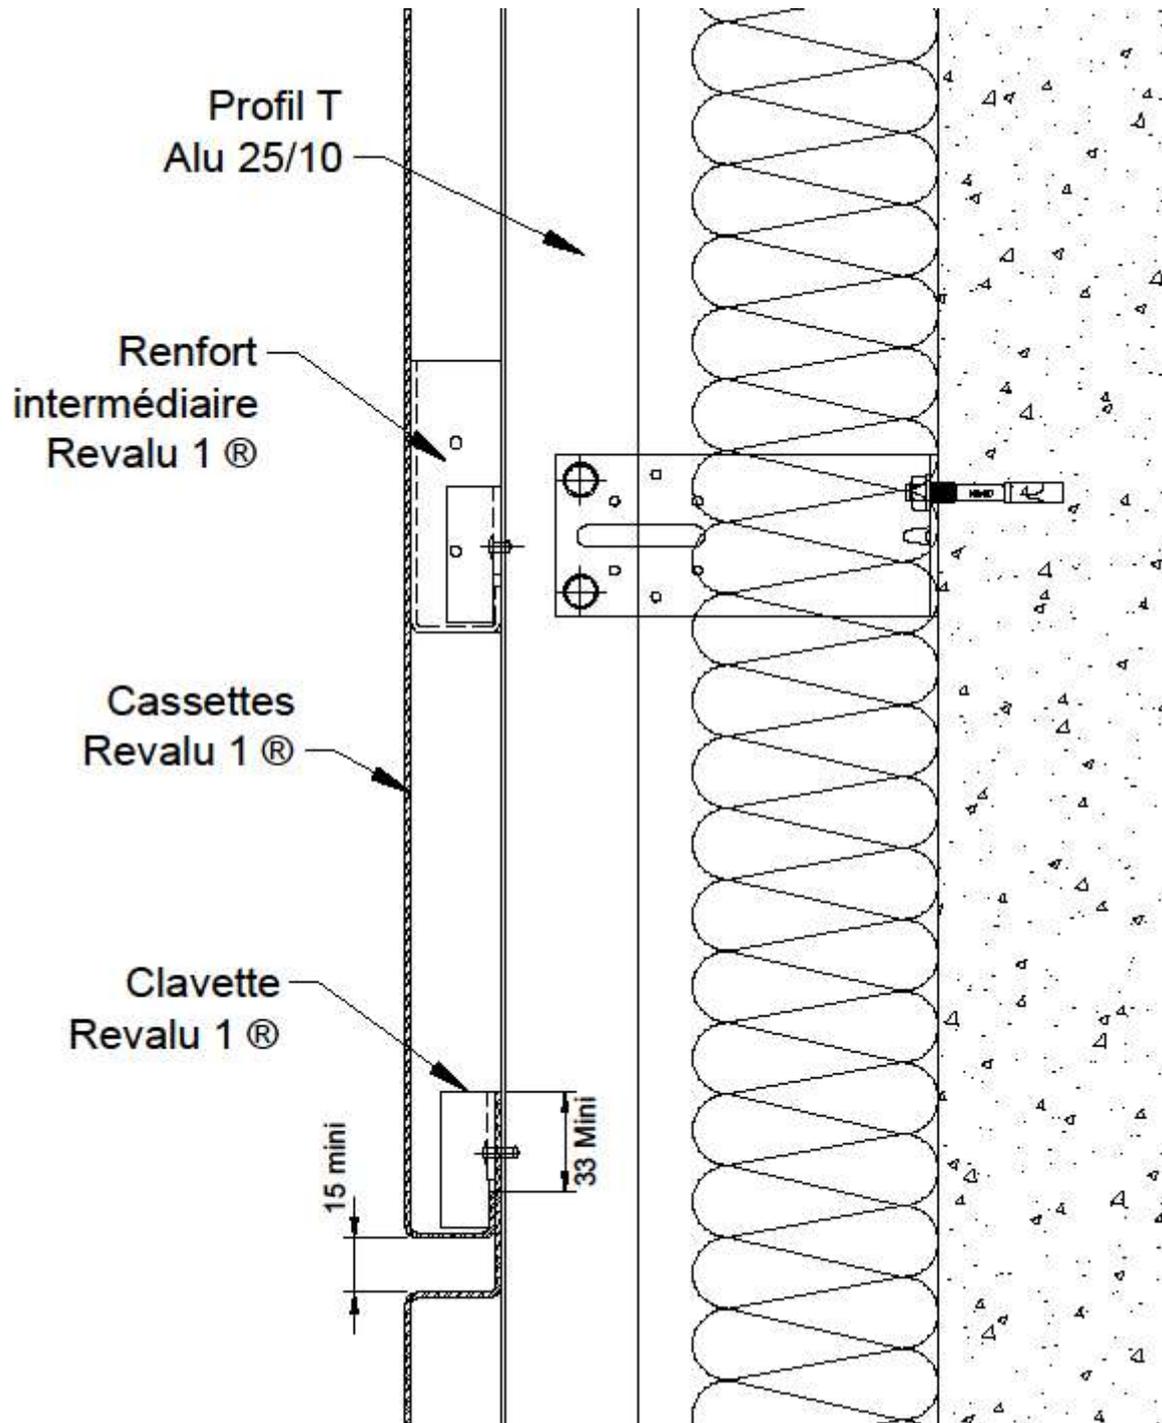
Coupe verticale sur joint horizontal (pose verticale)
